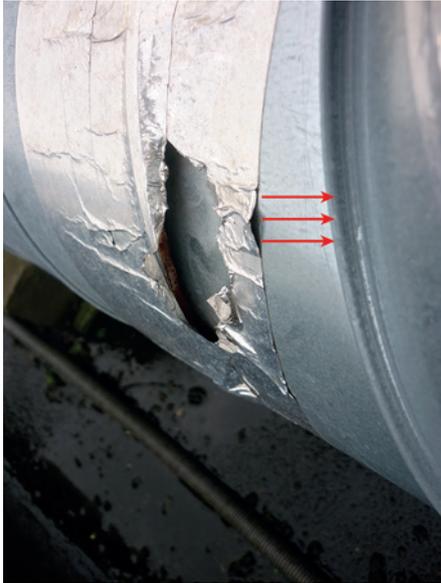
Défaut de raccord entre conduits au niveau d'un conduit circulaire
